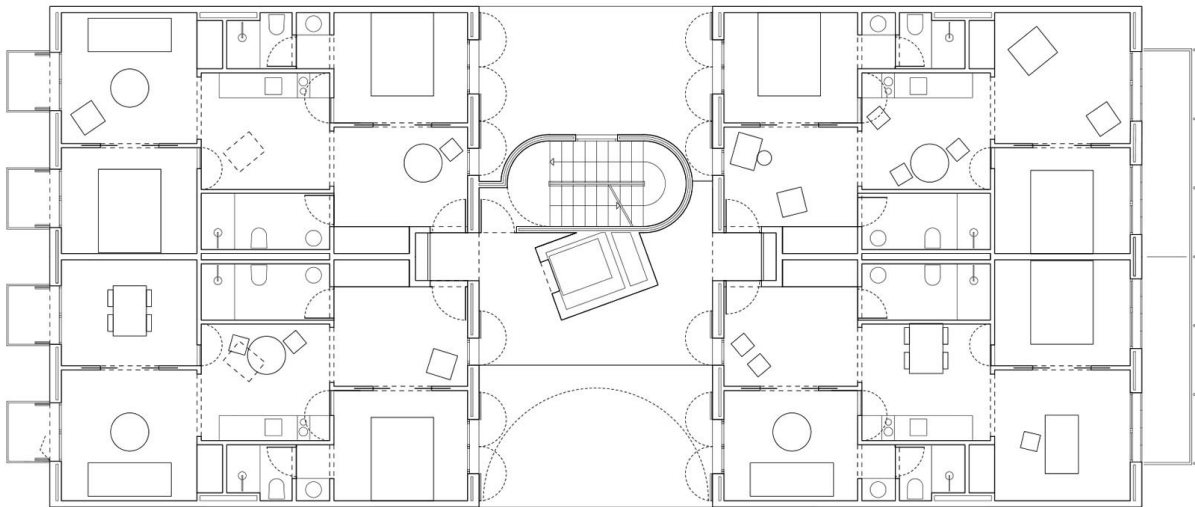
Planta tipo del proyecto 110 rooms de MAIO.
